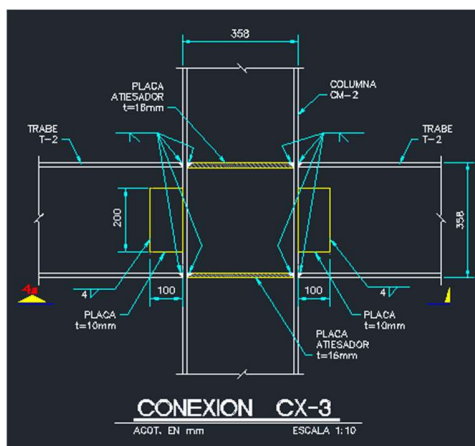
Detalle de conexión de estructura de elevador. Elaborado por el autor.
